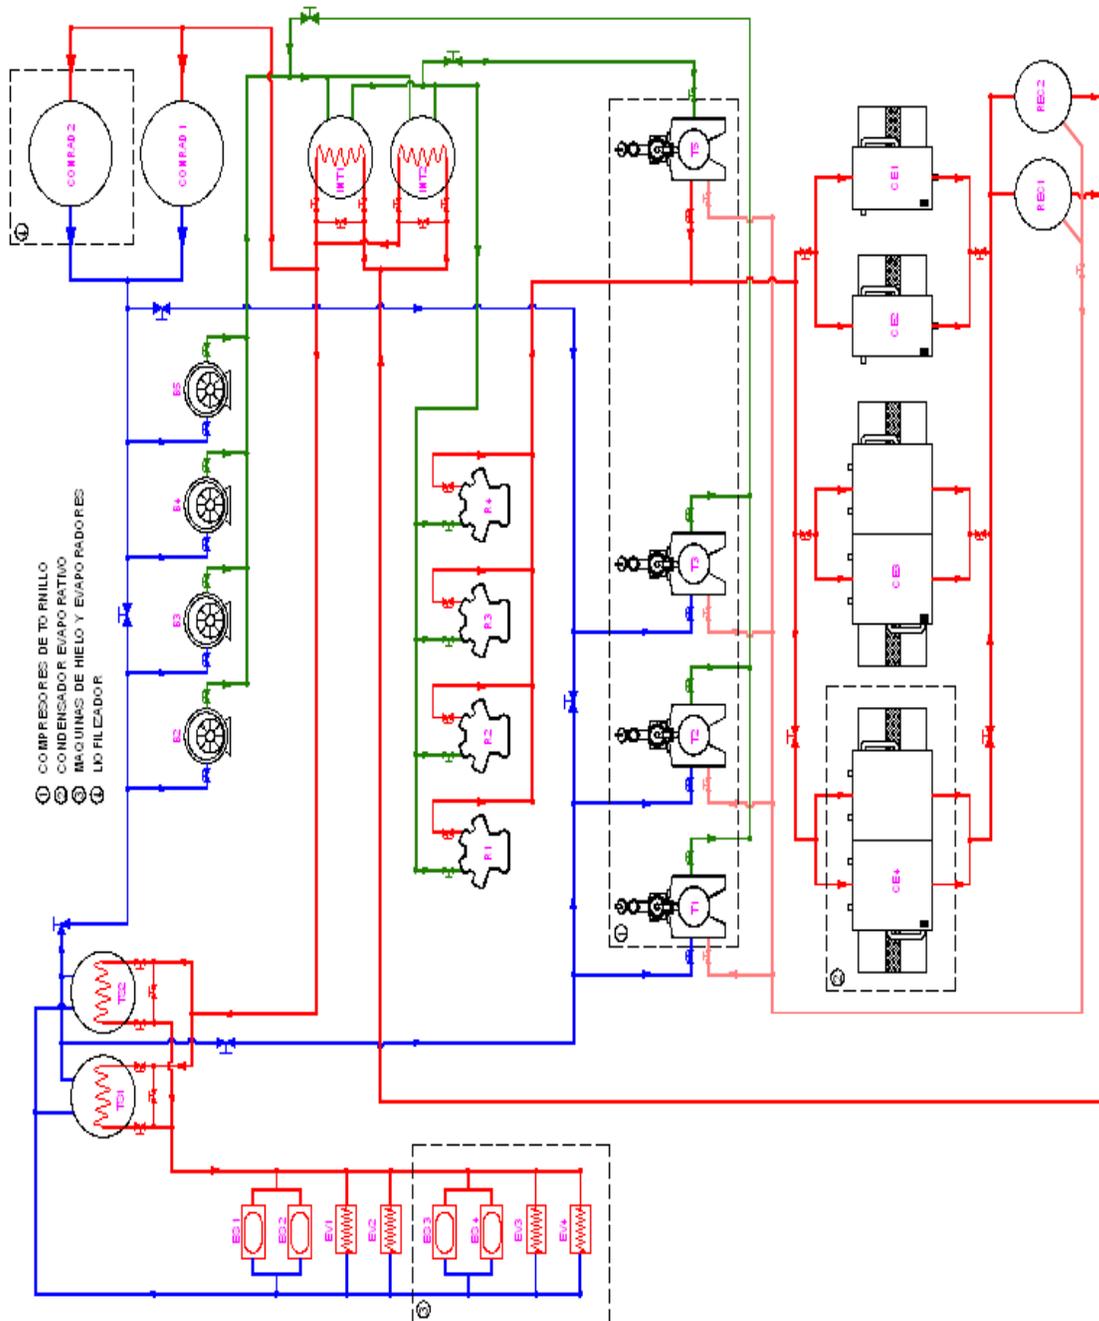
Diagrama Final de la Planta de Refrigeración
